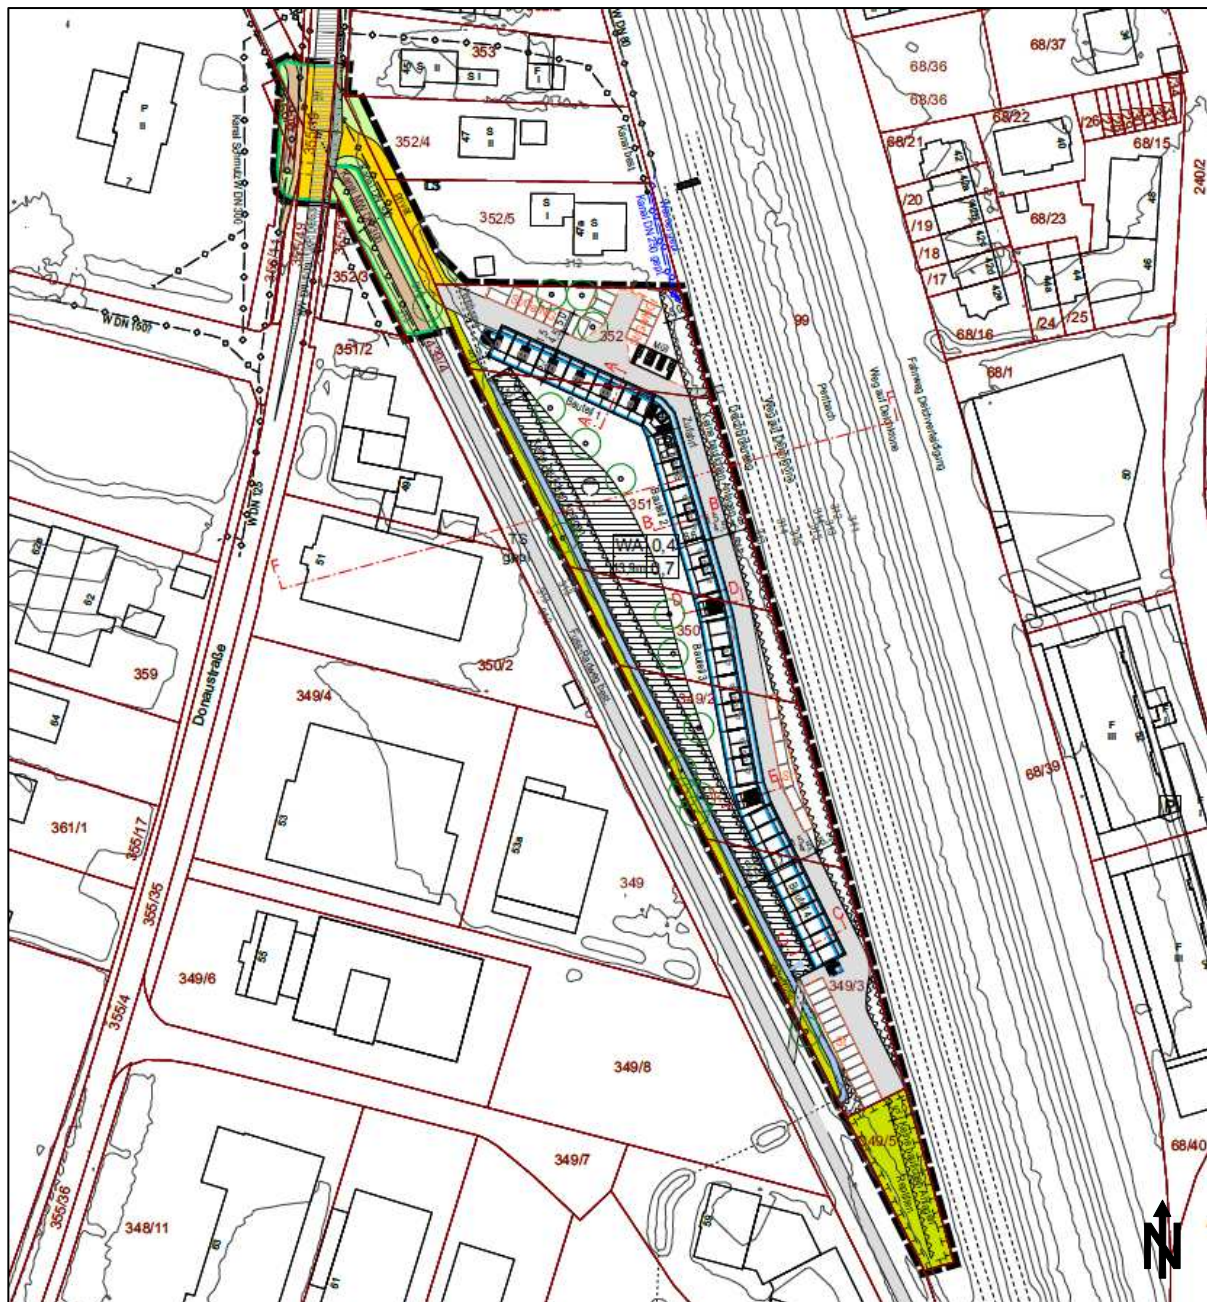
zeigt Schnitte durch die Baukörper gemäß (d) und Abbildung 3 die Planzeichnung zum Bebauungsplan (i).
